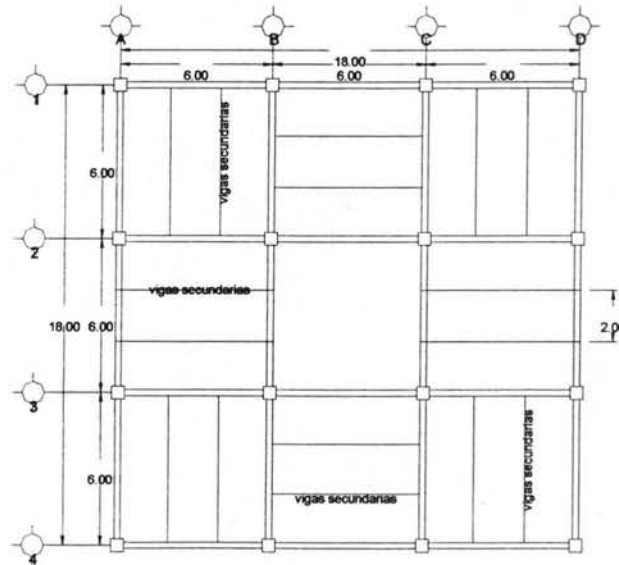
Planta Tipo del Edificio, Caso 2
